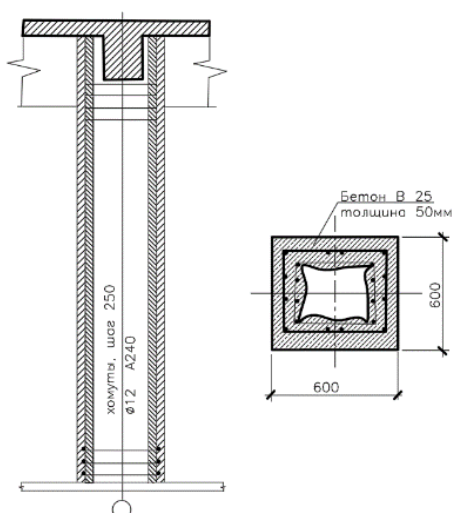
Фрагмент схемы усиления колонны путем наращивания бетона
